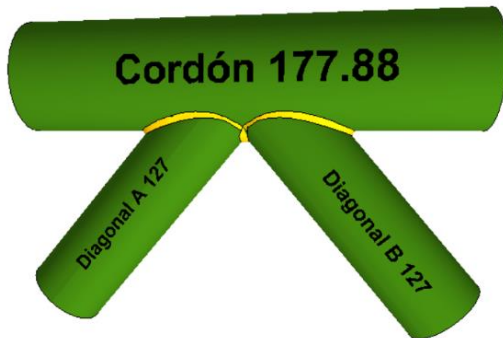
Unión soldada cordón-diagonales.
